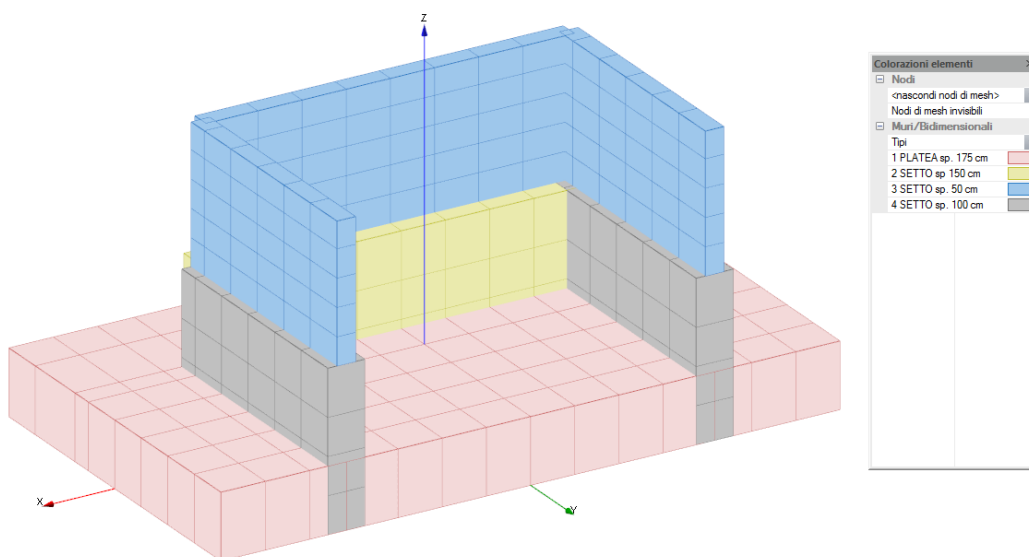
VISTA TRIDIMENSIONALE SOLIDA MODELLO SPALLA 2 – LATO MONTE
